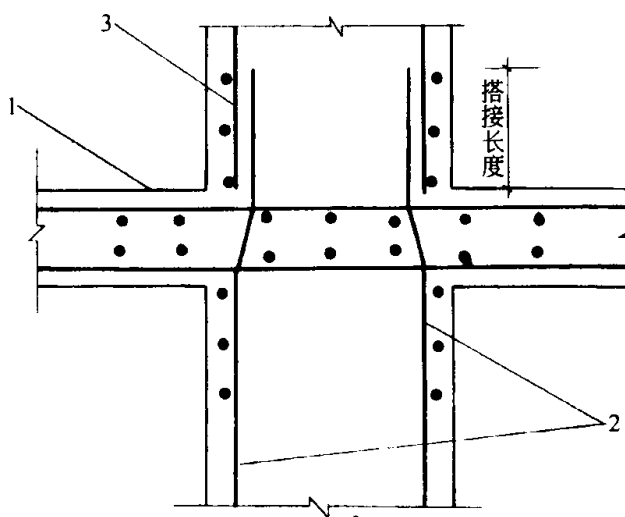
钢筋焊接网的竖向搭接图
